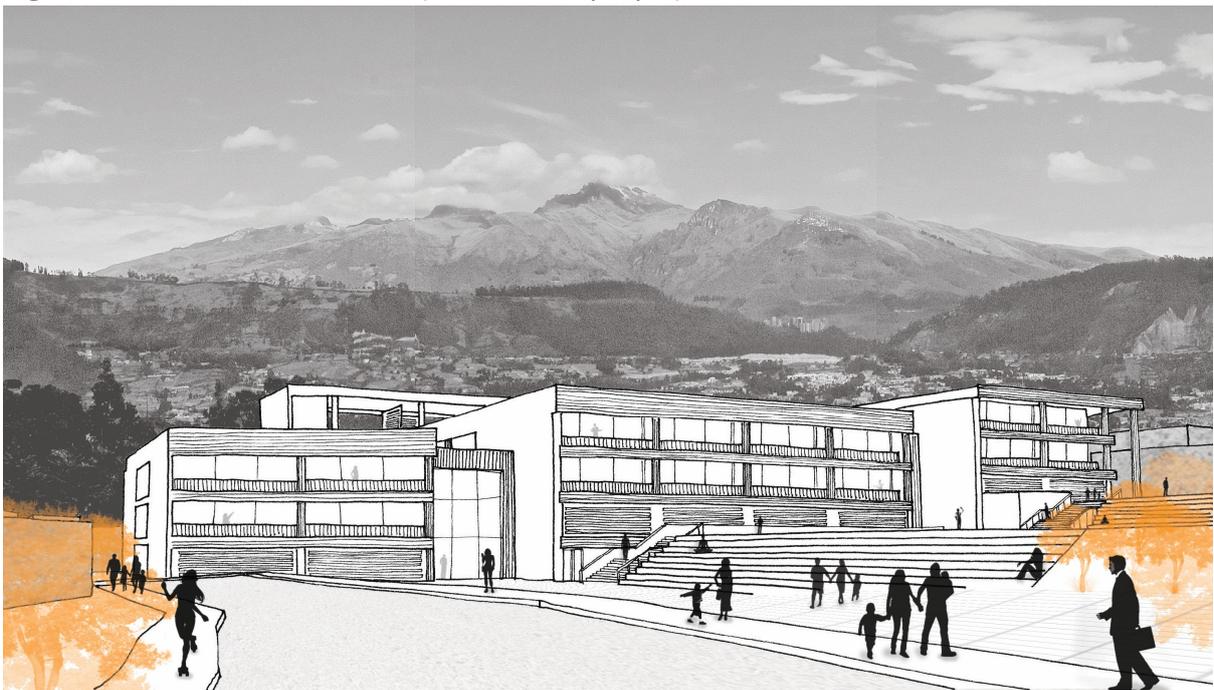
Vista desde Plaza Exterior (elaboración propia)
